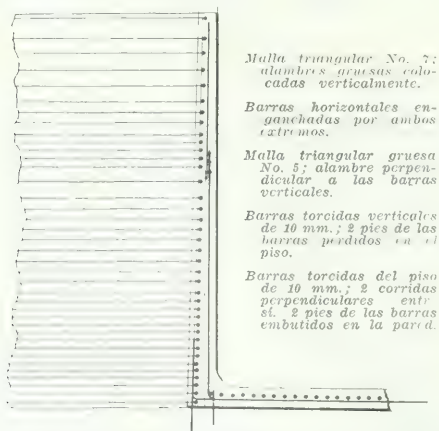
DETALLES DEL REFUERZO DE UN DECANADOR
